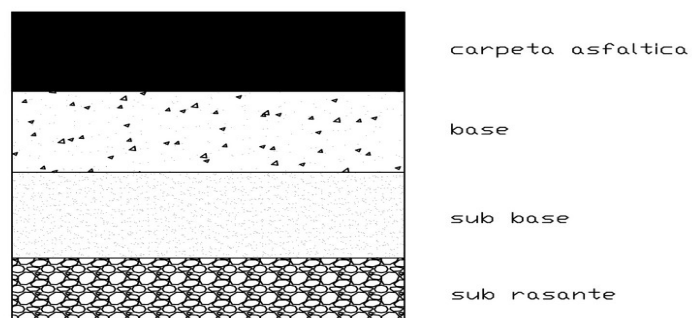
Estructura de un pavimento asfáltico sobre la subrasante
